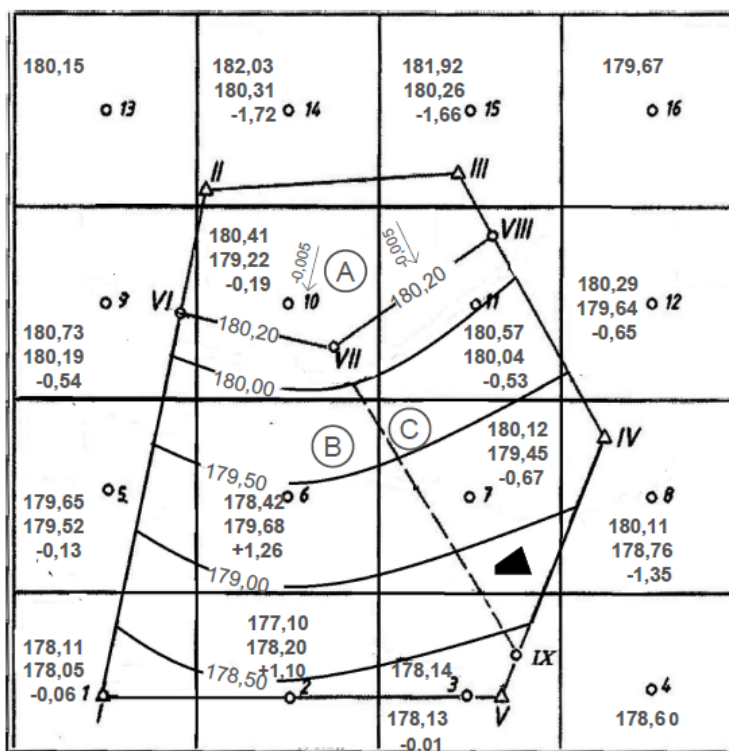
Оптимальный план вертикальной планировки при:
